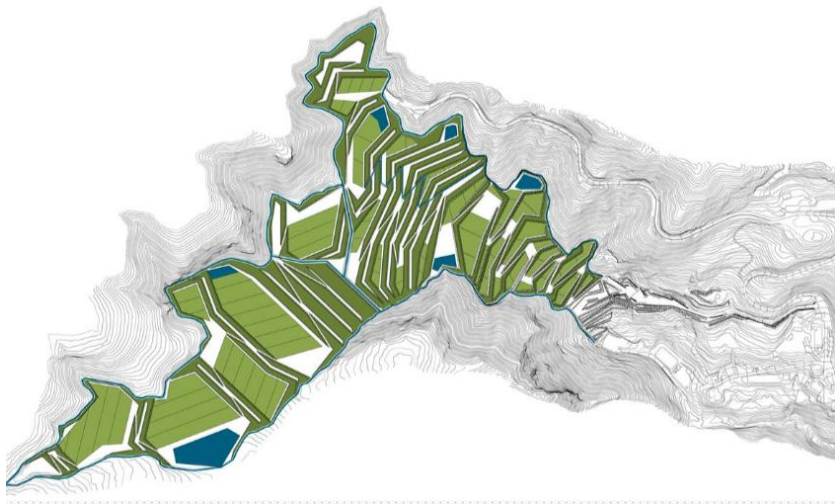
Planta general del proyecto. Fase 1, 2, 3 y 4. Fuente: Batlle I Roig.
